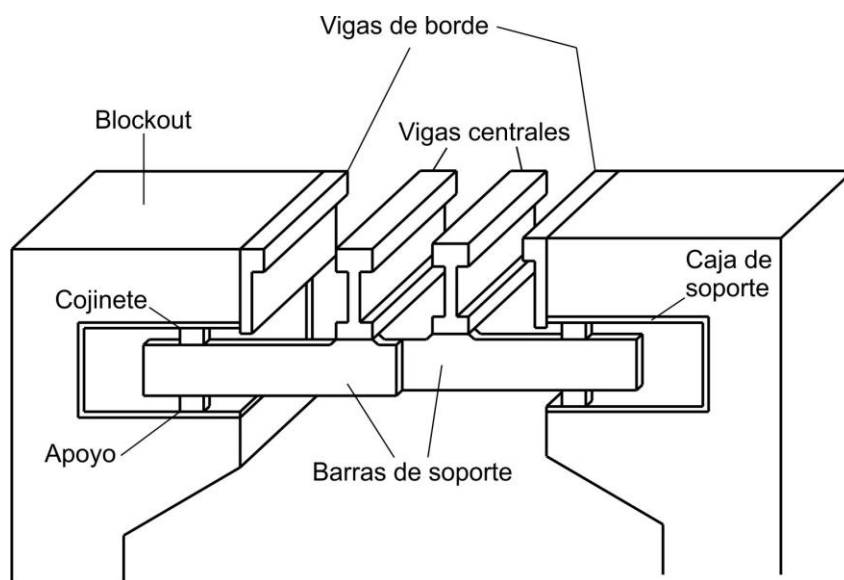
Vista de la sección transversal de un sistema de junta de puente modular típico (MBJS) de múltiples barras soldadas de soporte (WMSB) que muestra las barras de soporte deslizándose dentro de las cajas de soporte.
